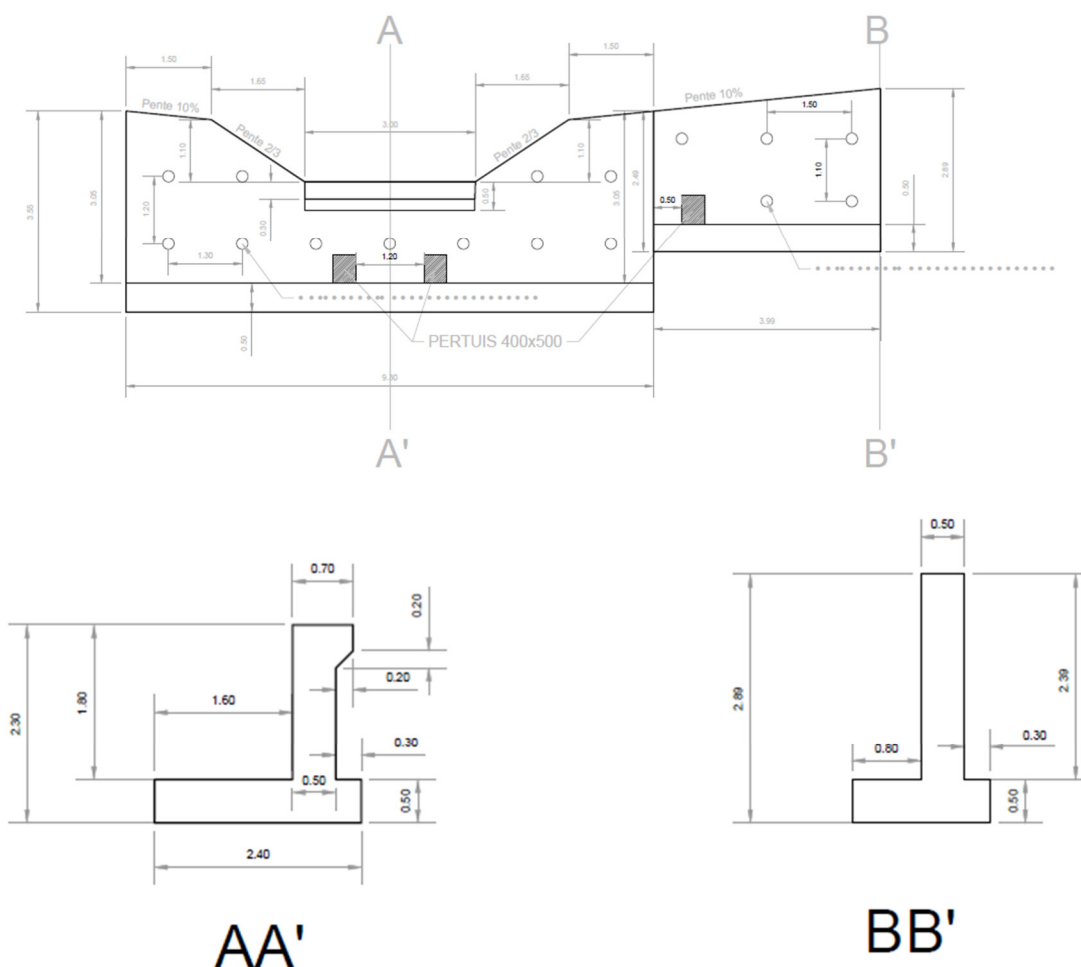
Vue en plan et en coupe des ouvrages auto stables pour le corps central et l'aile rive gauche, cas seuil 16
